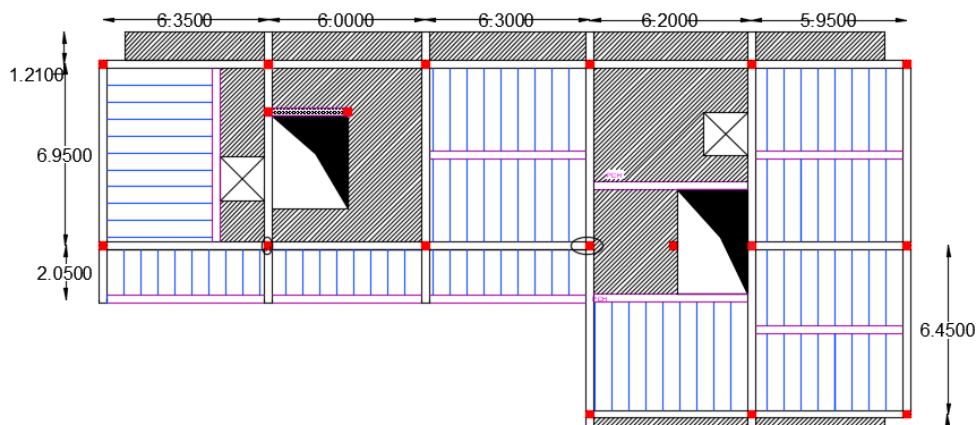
disposition des poutrelles de la terrasse inaccessible
